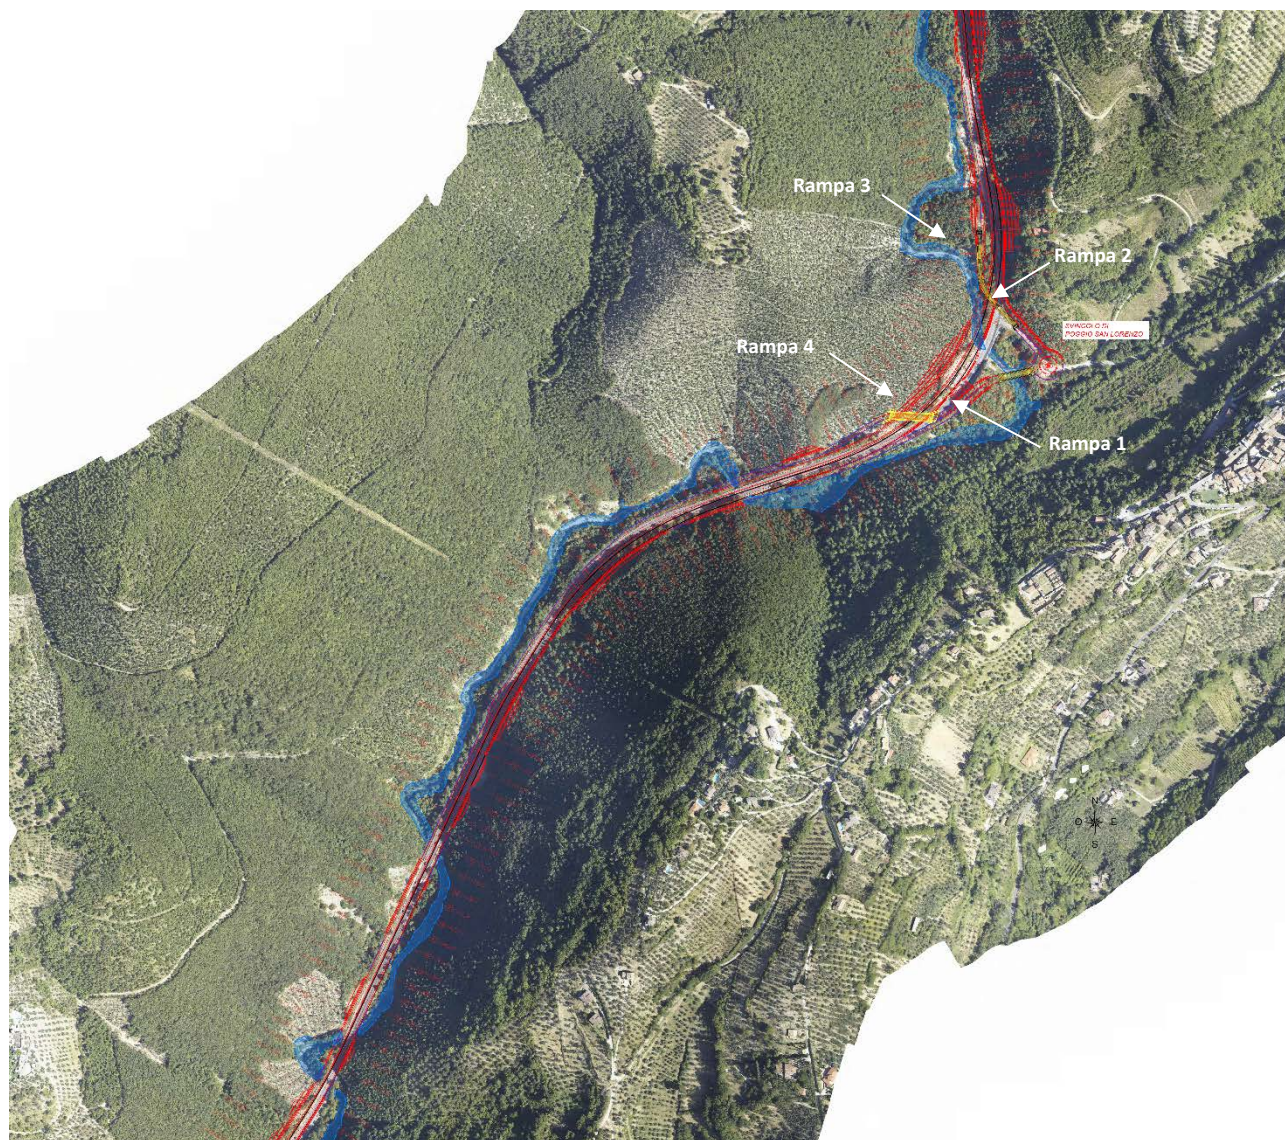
Lotto 1: tracciato di progetto su ortofoto dalla pk 1+300 alla pk 3+300
